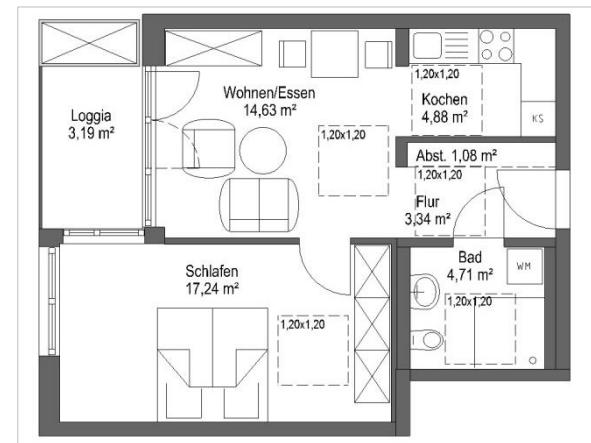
Darstellung kompakter Grundriss mit Abstandsflächen
